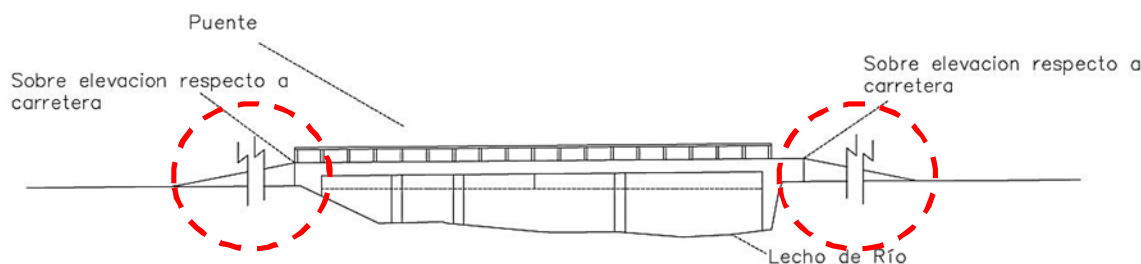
Esquema de puente con sobre elevación respecto a los extremos de aproximación.
